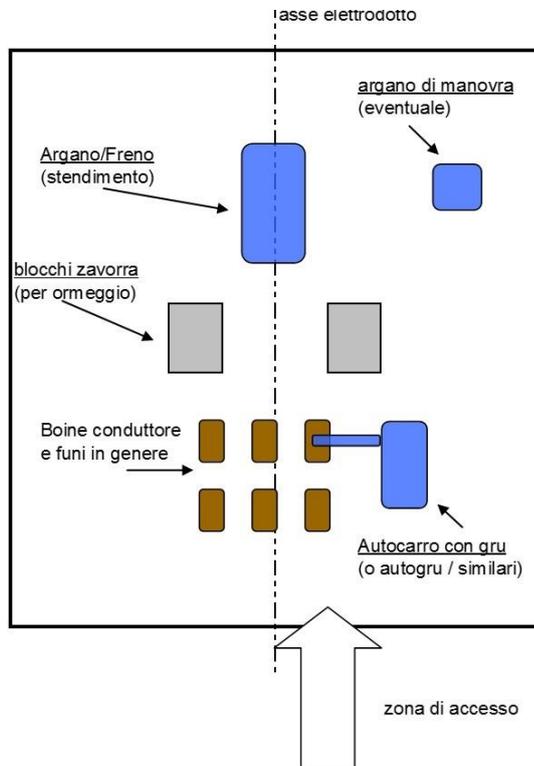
Planimetria dell'Area Sostegno (montaggio sostegno) - Planimetria dell'Area di linea – Tipologico
